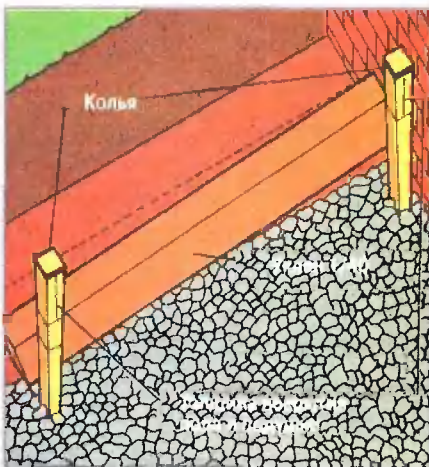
Уклон откладывают на колья, забитых у стены дома до уровня верхней отметки покрытия пола
